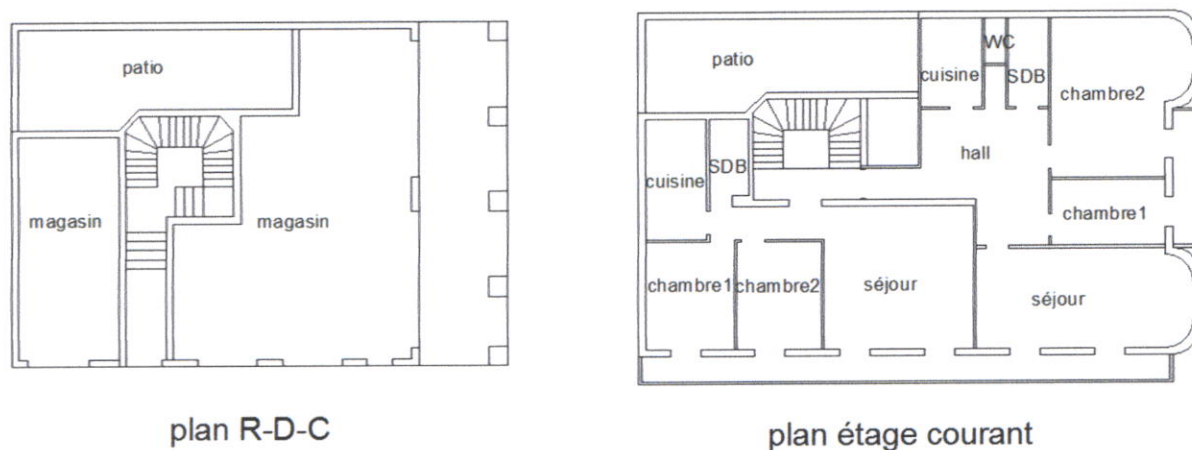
les plans d'un immeuble de rapport, source : relève faite par notre groupe en
